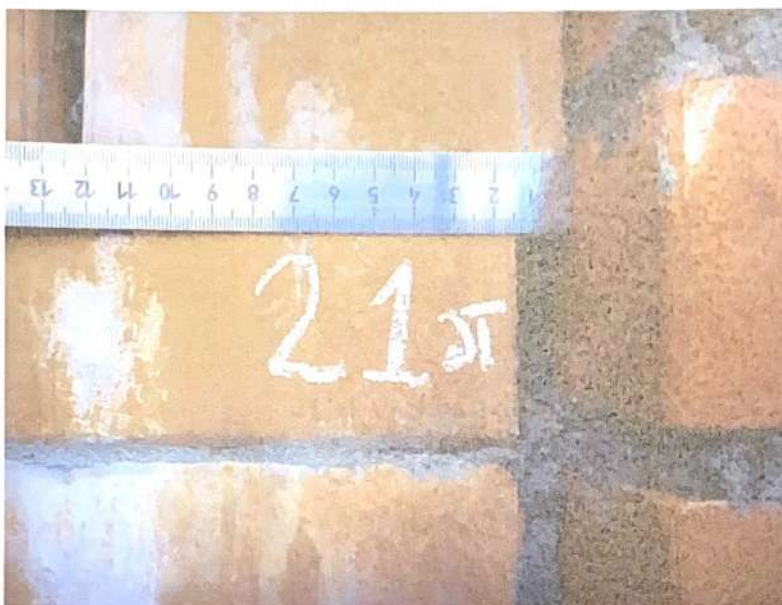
Секция 11. Фасад 2. Дефекты швов кладки-пустошовка.
